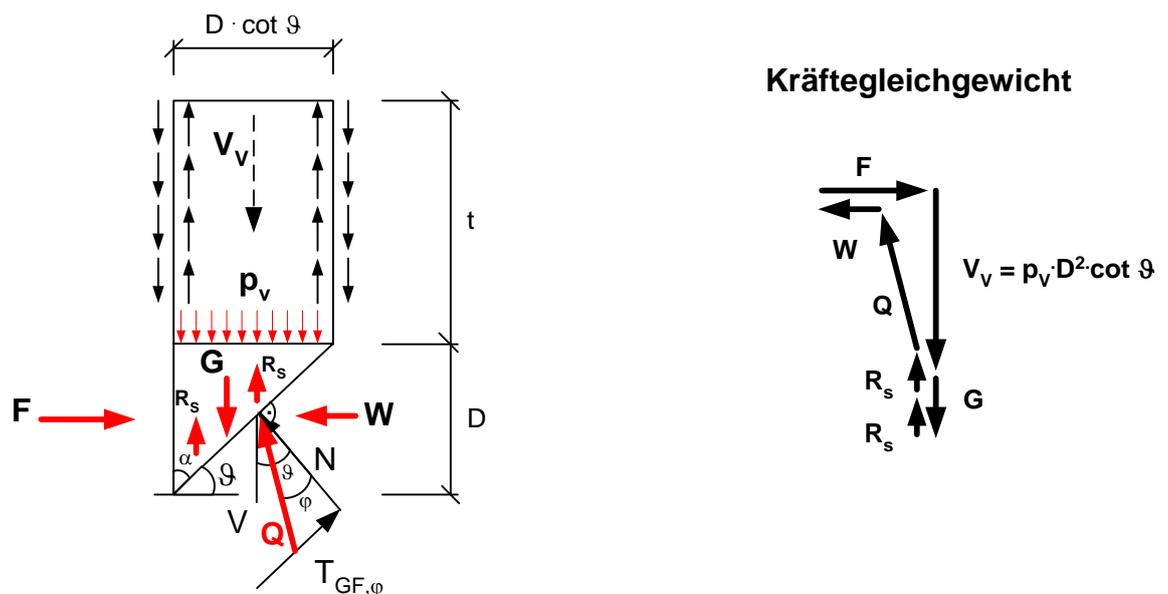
Kräftegleichgewicht am Bruchkörpermodell
